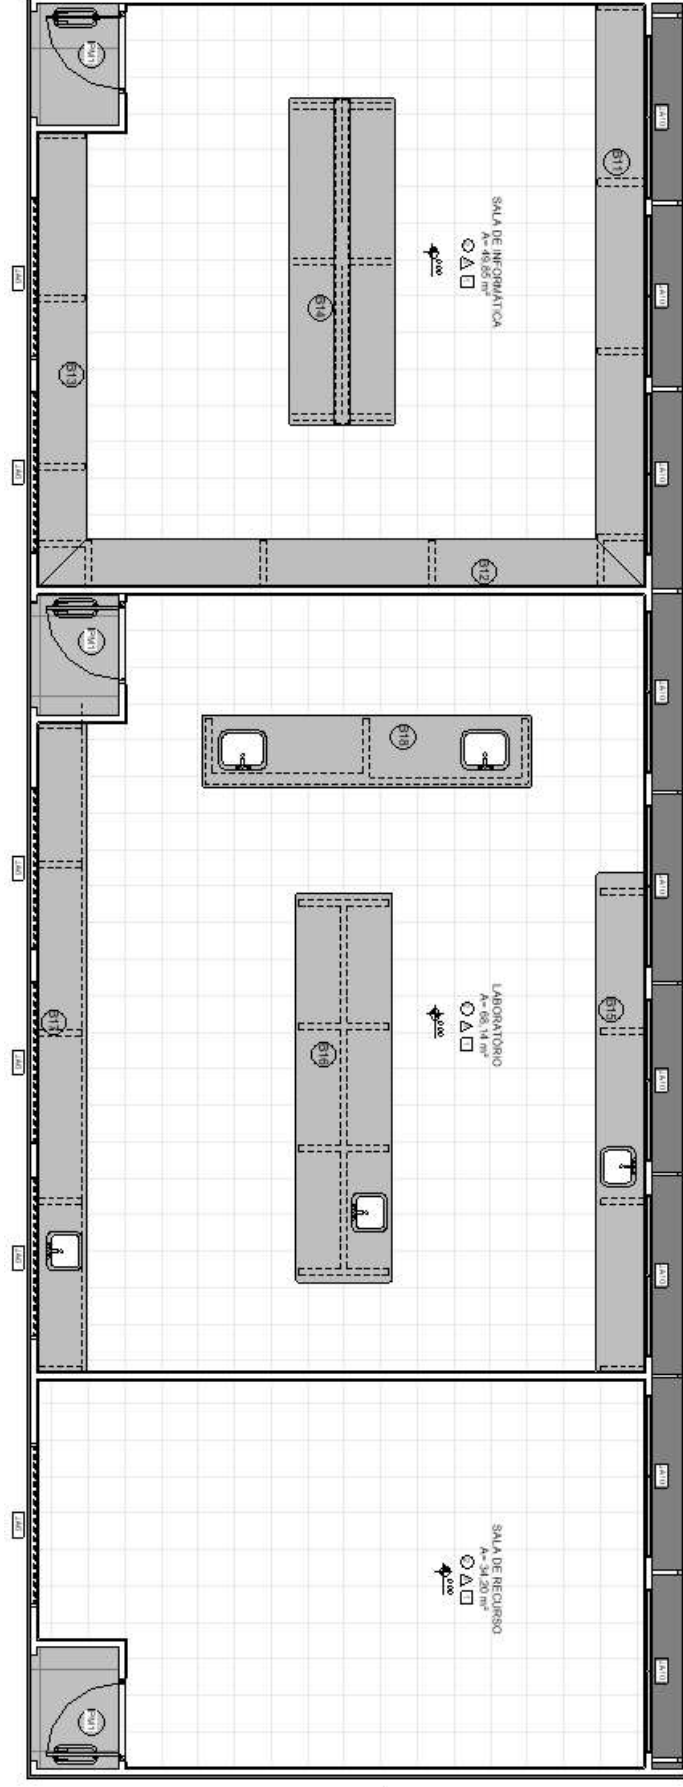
Planta Baixa de Implantação – Bloco C (Laboratórios)
